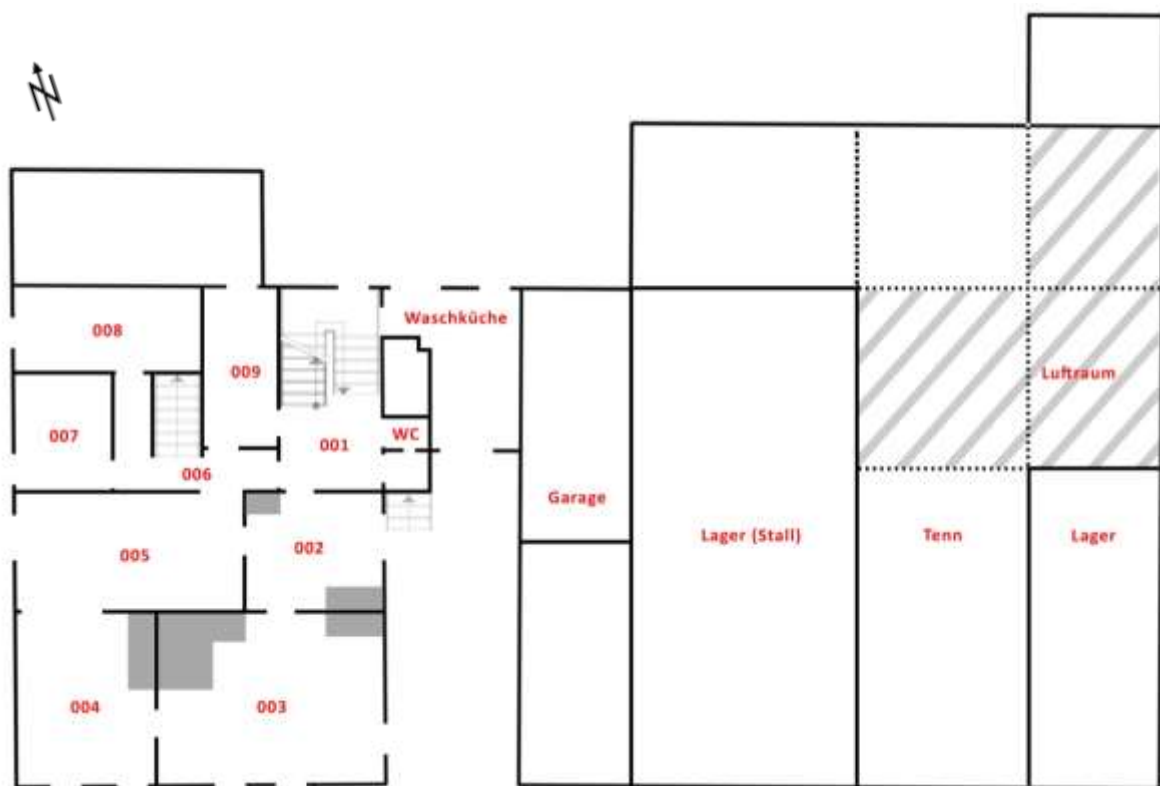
Schematischer Grundriss Erdgeschoss. Bearbeitung IBID.
